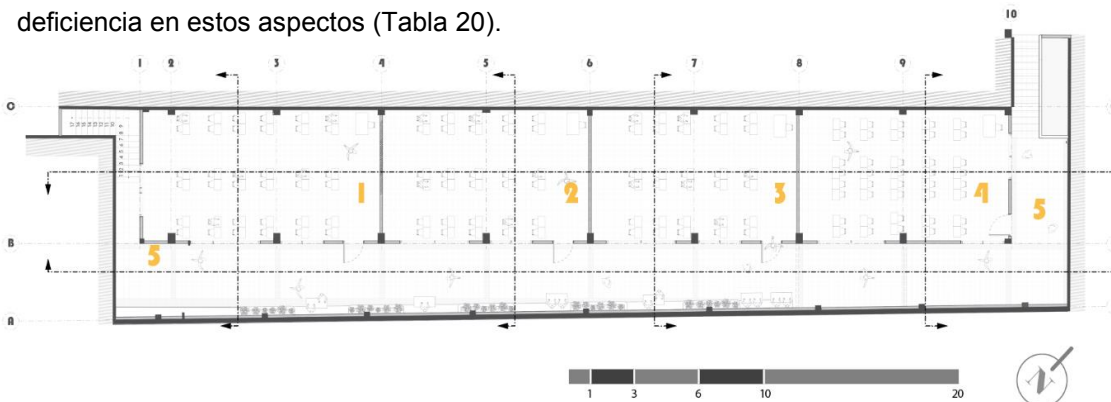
Planta del subsuelo de la unidad académica ingeniería, industria y construcción.
